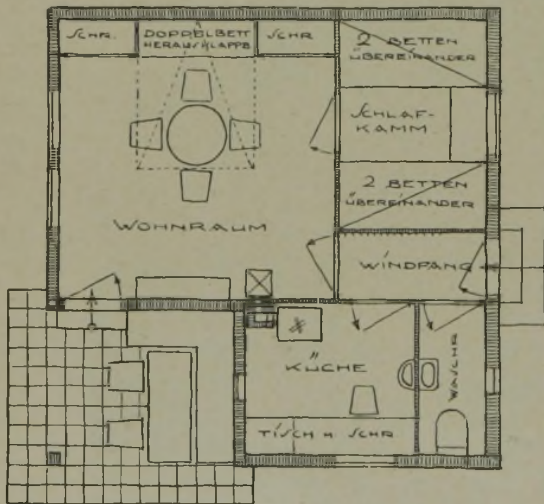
Grundriß des Wochenendhauses. (1:100.)
